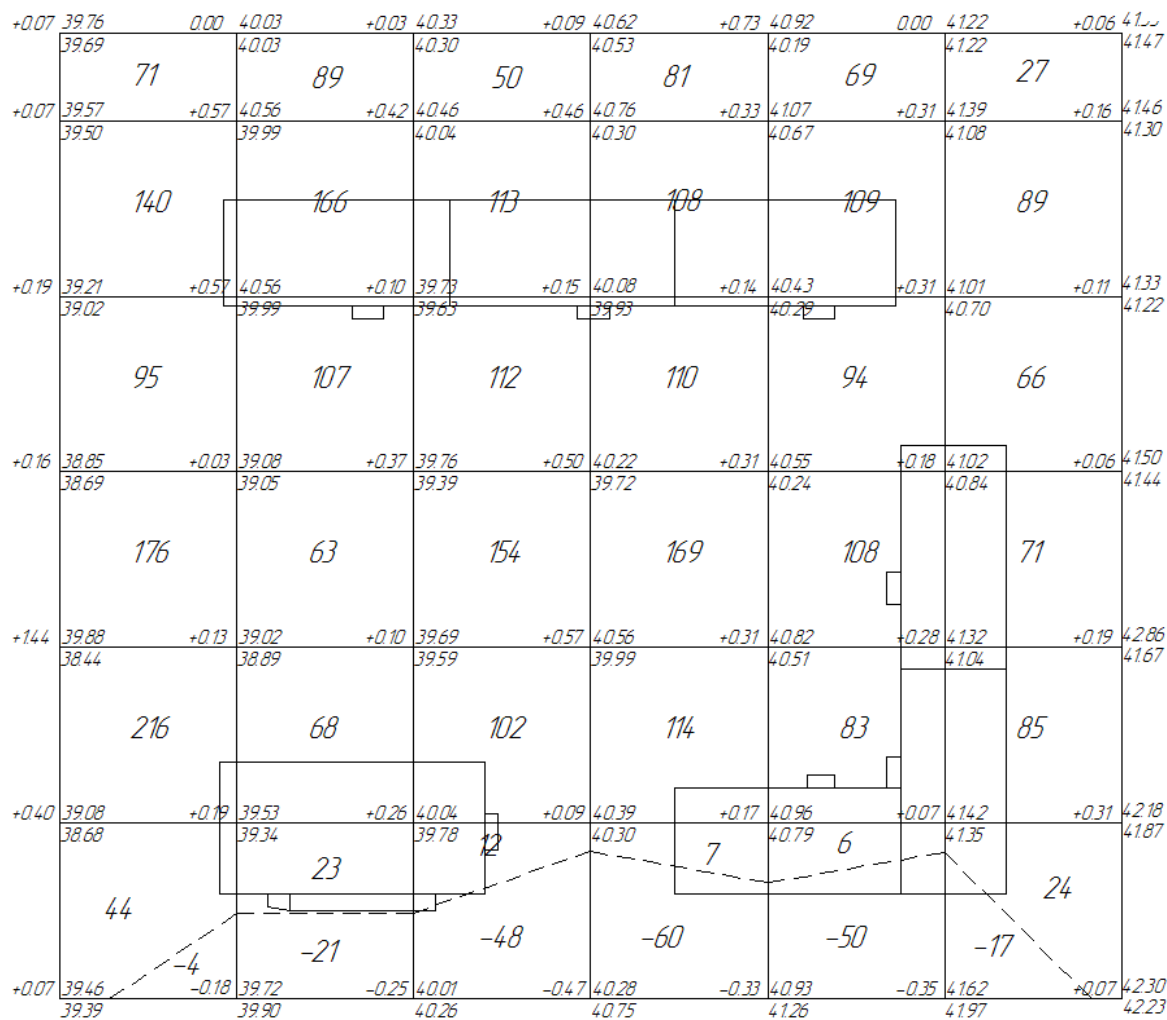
Фрагмент определения отметок плана земляных масс
